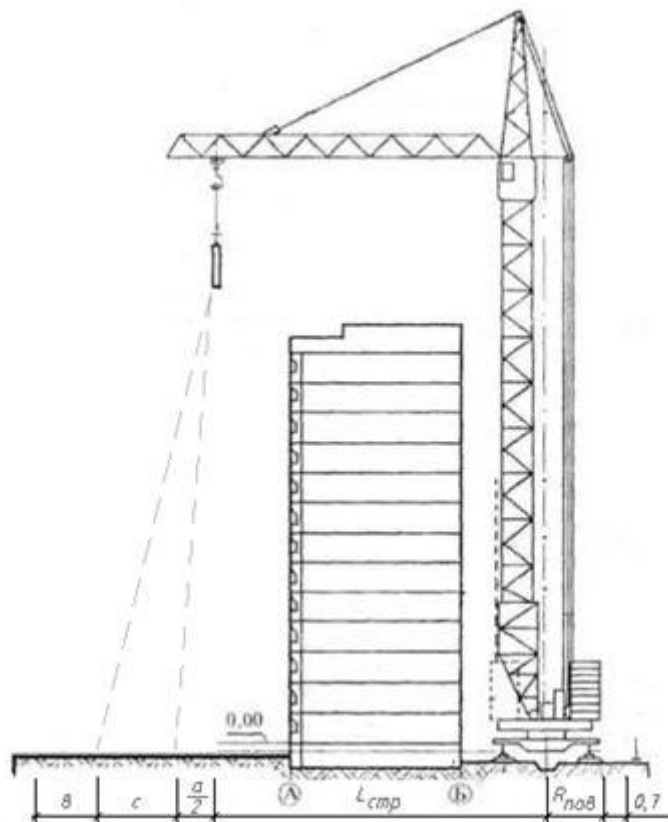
3– Привязка башенного крана к строящемуся зданию
